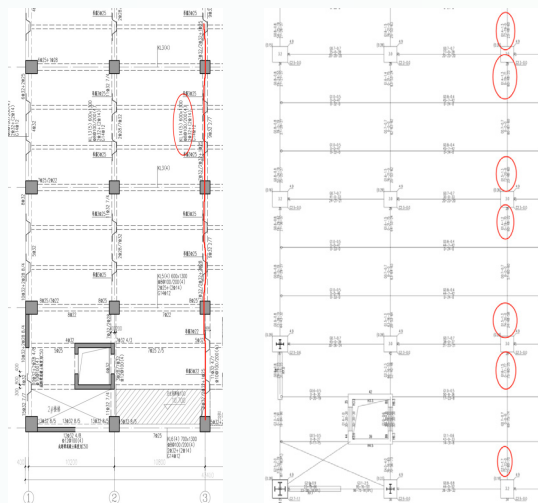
2#厂房首层顶梁配筋平面图及配筋简图(局部)
